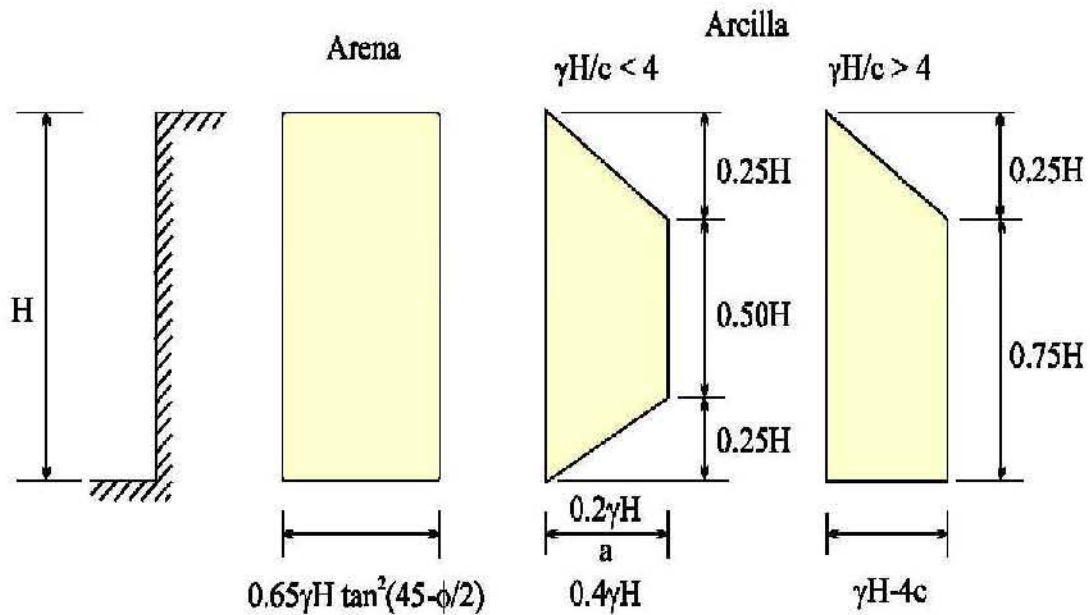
Diagramas de presión aparente para calcular las cargas en las Anclas.
